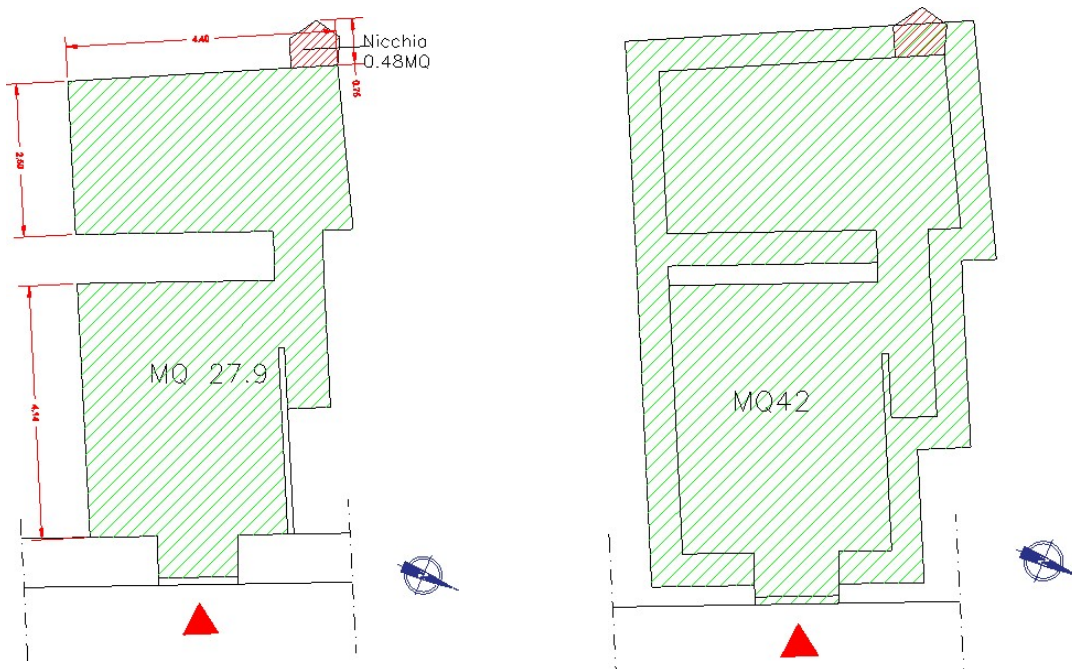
Planimetria delle superfici utili e commerciale
